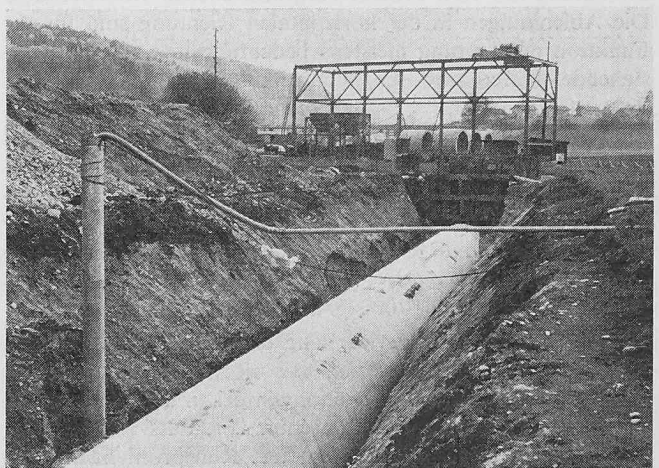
Pressrohrvortrieb «in offener Baugrube». Links ein Filterbrunnen, im Hintergrund Pressschacht
